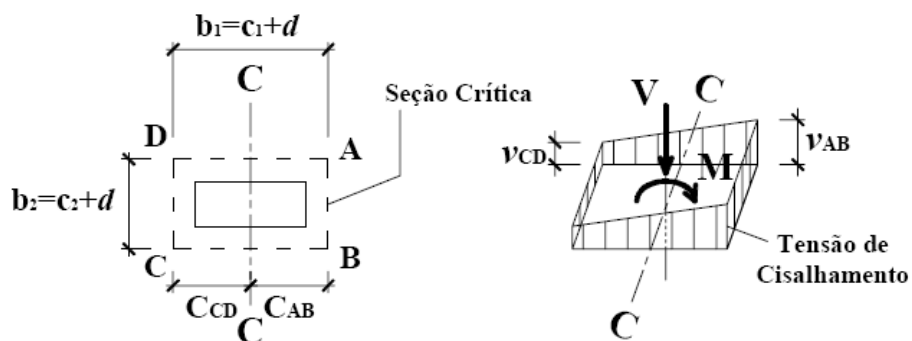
Localização da seção crítica para pilar interno e suposta distribuição das tensões de cisalhamento pelo ACI 318M-02
